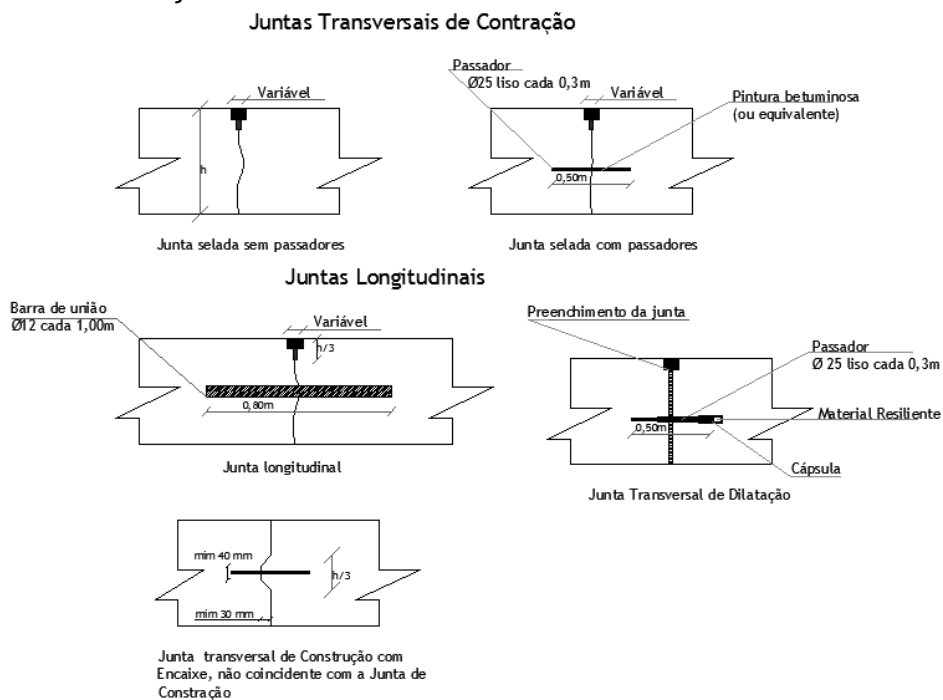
Tipos de juntas dos pavimentos rígidos
